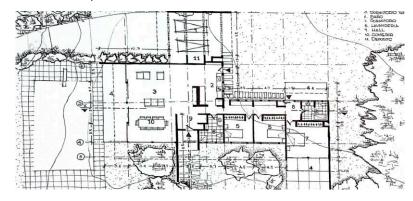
Planta arquitectónica | Casa Unifamiliar con Patio
